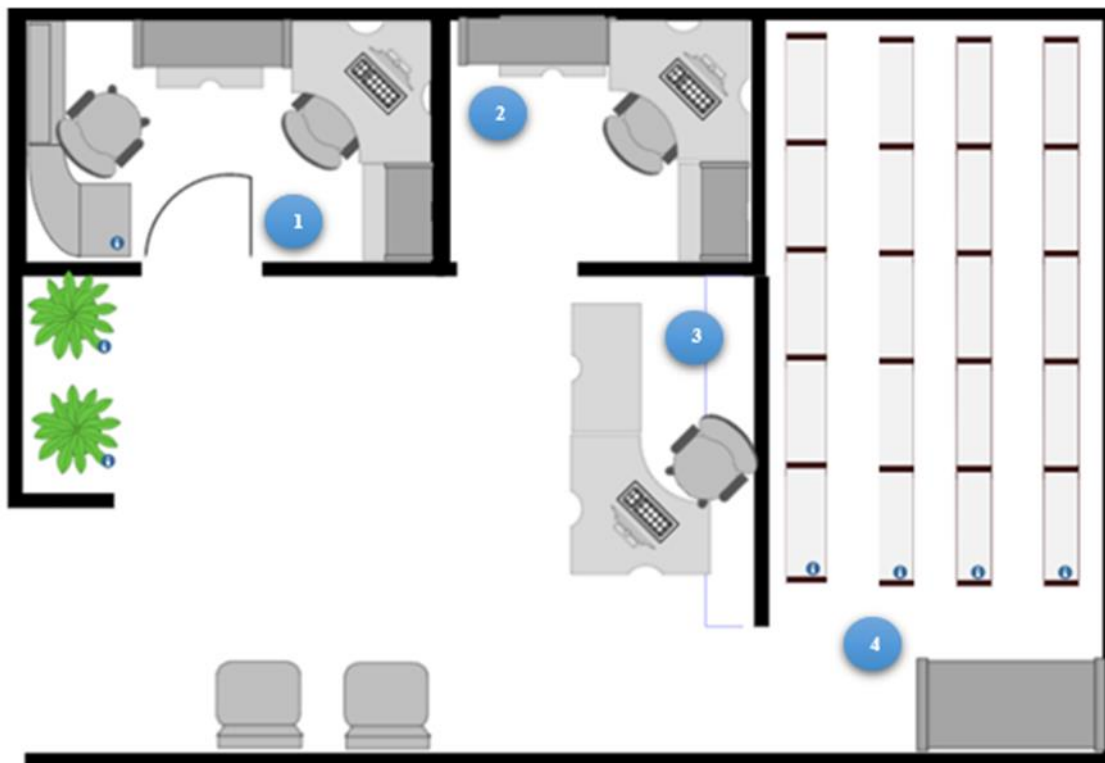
Distribución de planta (Fuente: elaboración propia de grupo)
